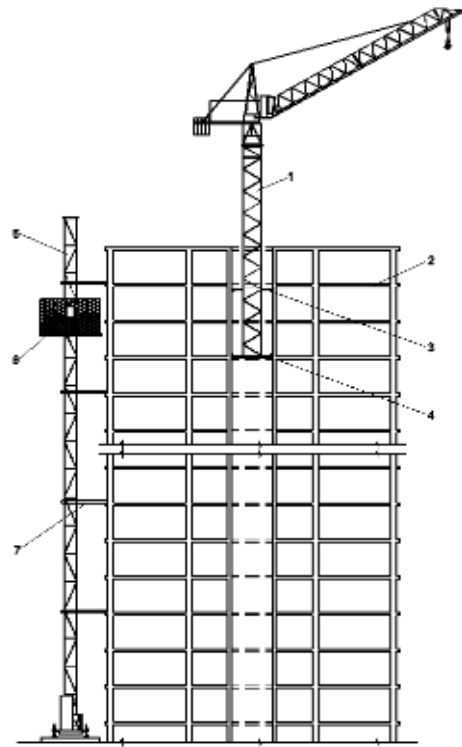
Схема установки самоподъемного башенного крана и грузопассажирского подъемника: 1 — кран; 2 — каркас возводимого здания; 3 — промежуточные опоры крана; 4 — нижняя опора крана; 5 — мачта подъемника; 6 — грузопассажирская кабина подъемника; 7 — монтажные связи подъемника [27]
